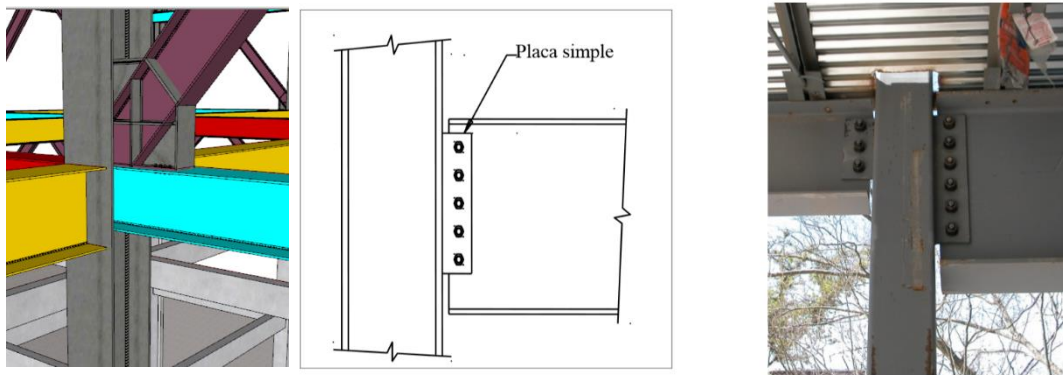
Viga cian: 0.35 m. de peralte. Conexión Viga-Columna: Placa simple (placa de cortante).
